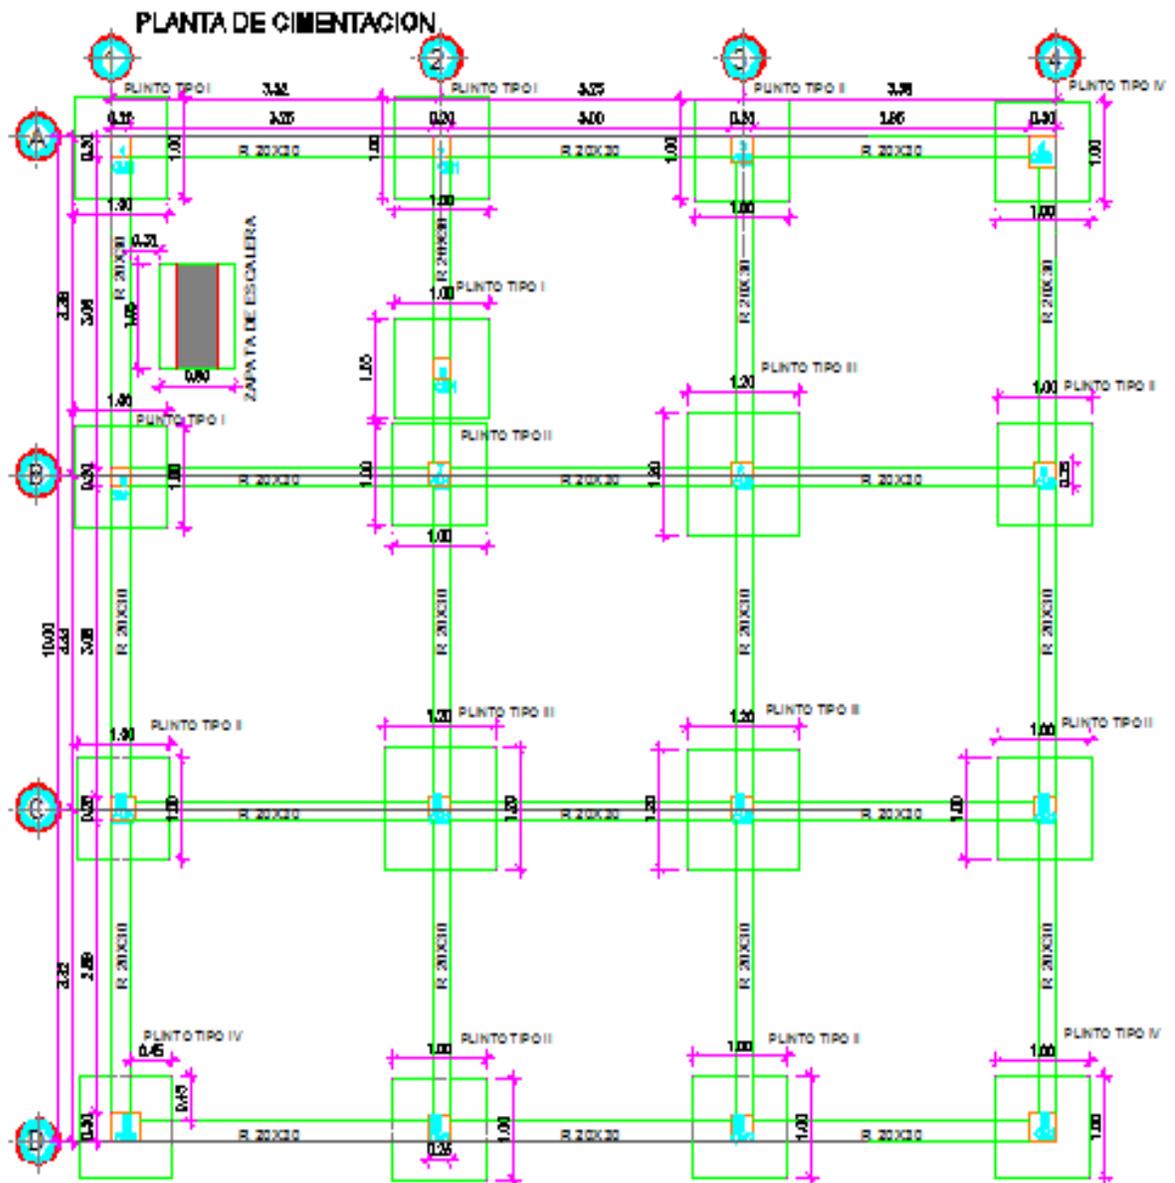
; Plano de cimentación del diseño de estructura metálica vista en planta.
